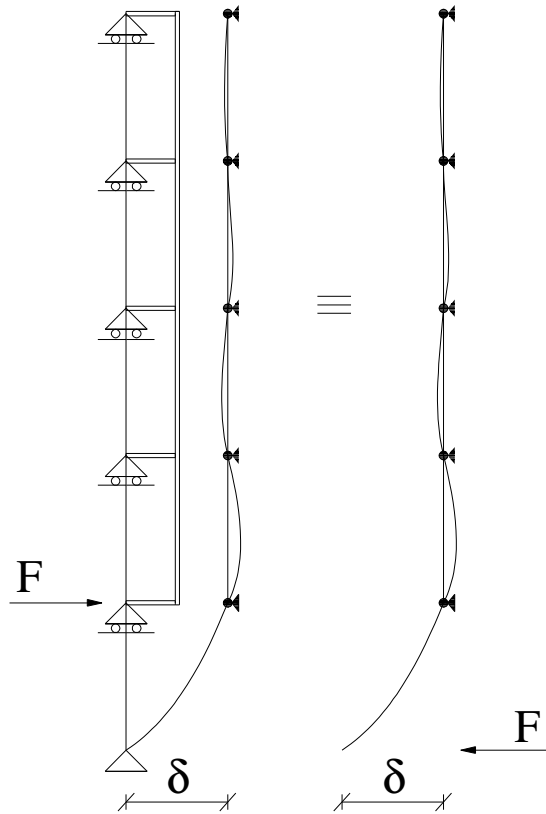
Schema statico della pilastrata dell’edificio a cinque piani.
